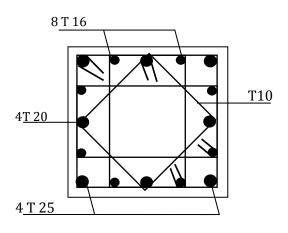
Schéma de ferraillage des poteaux RDC, 1^{er} étage.
